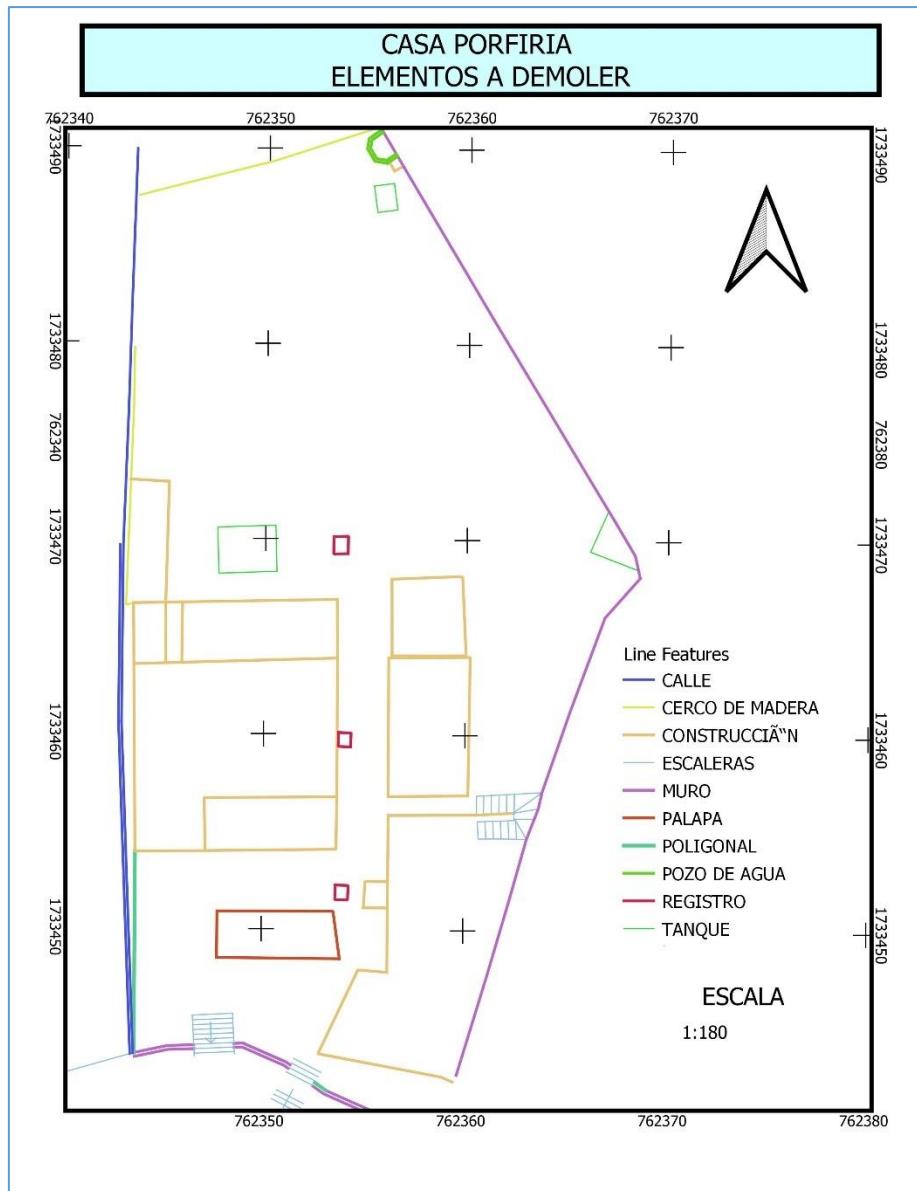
Plano de los elementos que se pretenden demoler .
